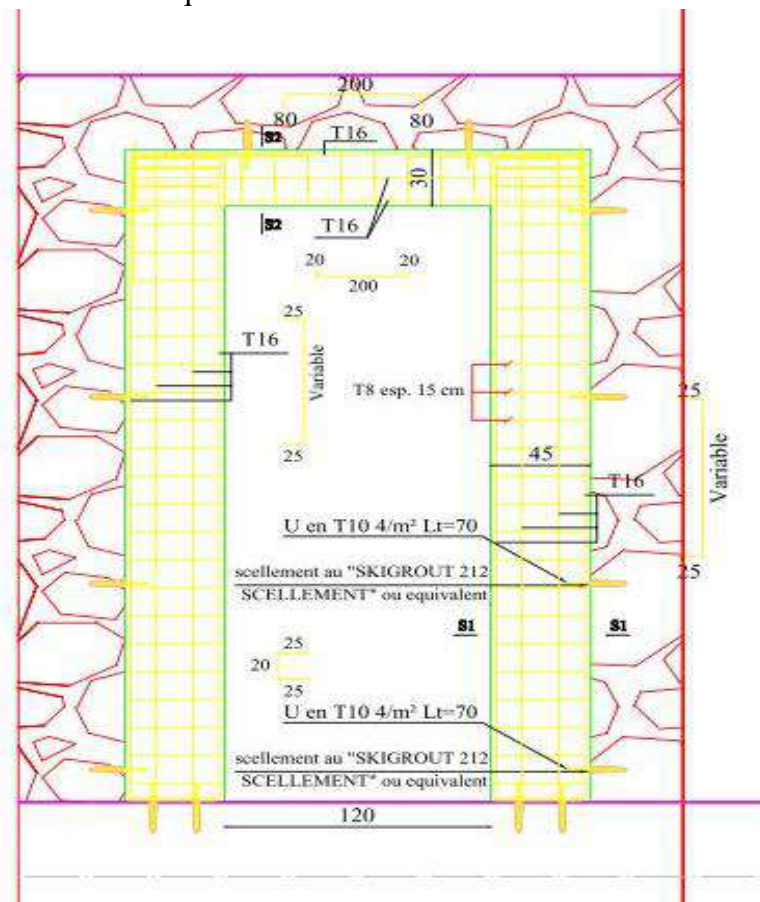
2 : Détails constructifs d'une porte, source : dossier graphique béton et béton armé réalisée par l'ingénieur du BET
